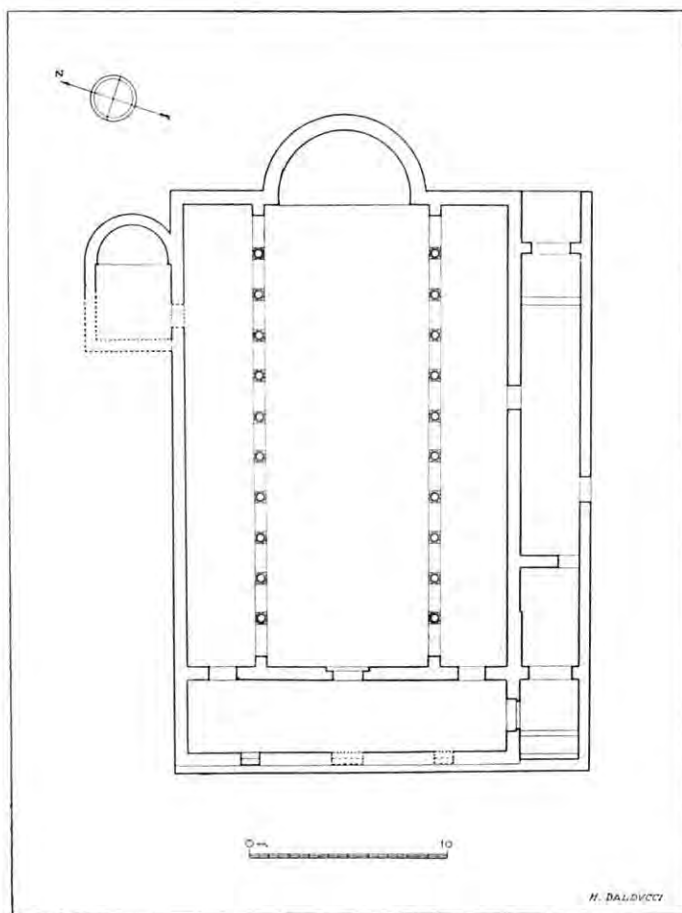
Planimetria reintegrata della basilica di Camares.
